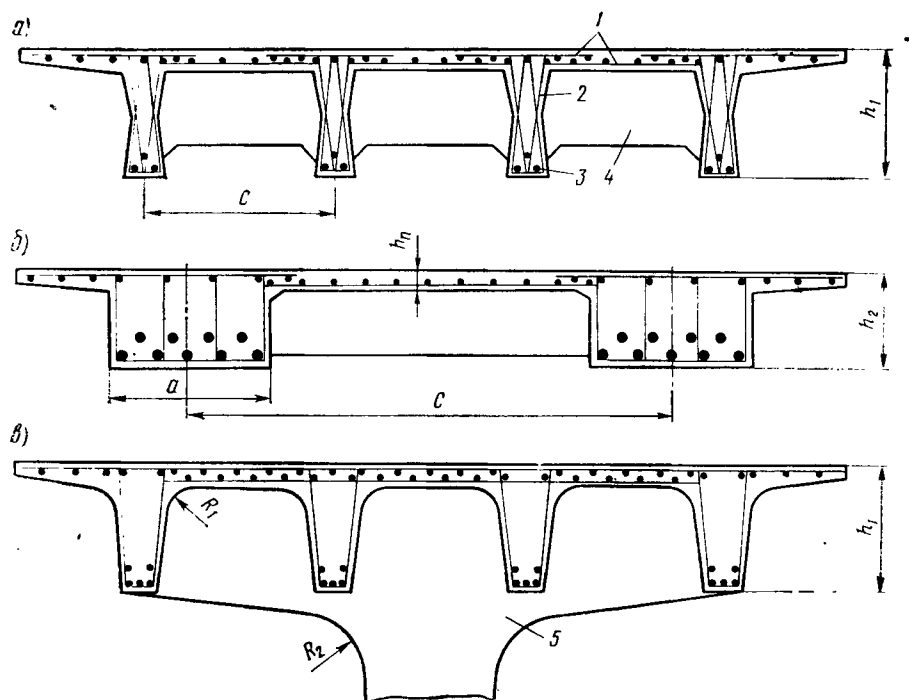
Типы поперечных сечений и армирование монолитных ребристых пролетных строений:
